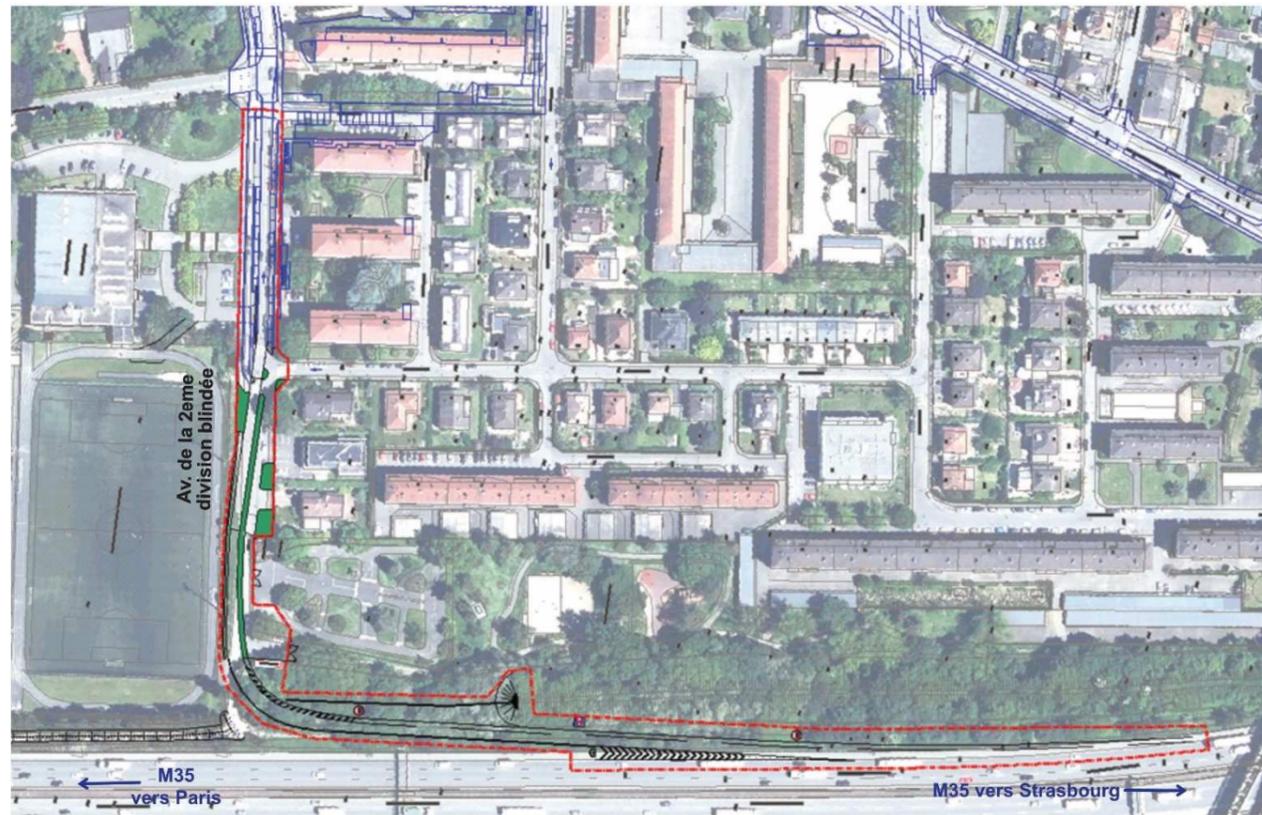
PLAN DE LA VARIANTE RETENUE POUR L'AMENAGEMENT DE LA BRETELLE BRIQUETERIE/2IEME DB
